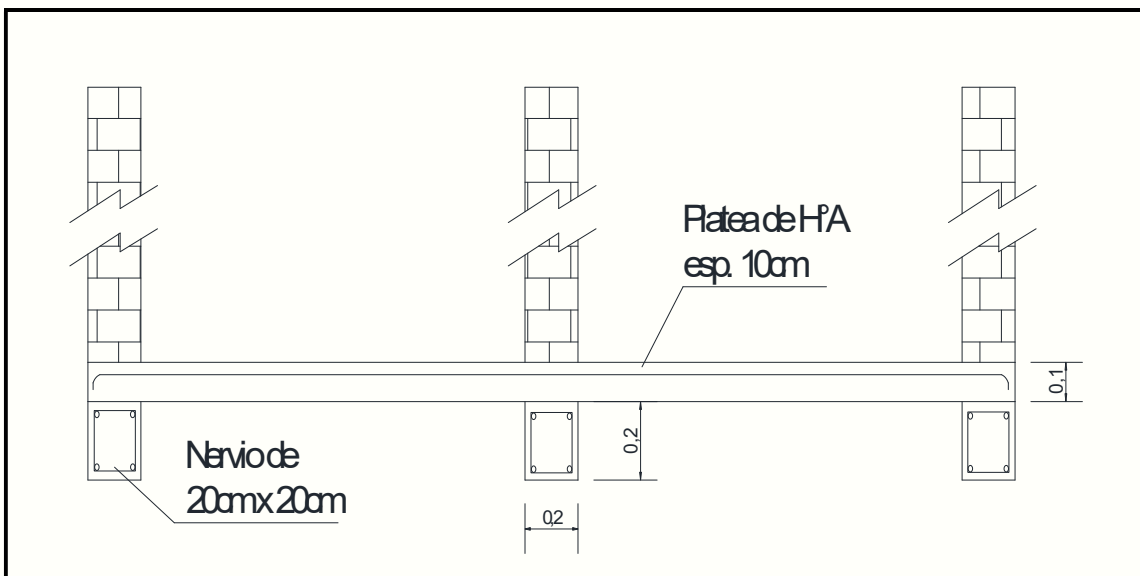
Detalle constructivo de fundación tipo platea con refuerzos (fuente: elaboración propia).
